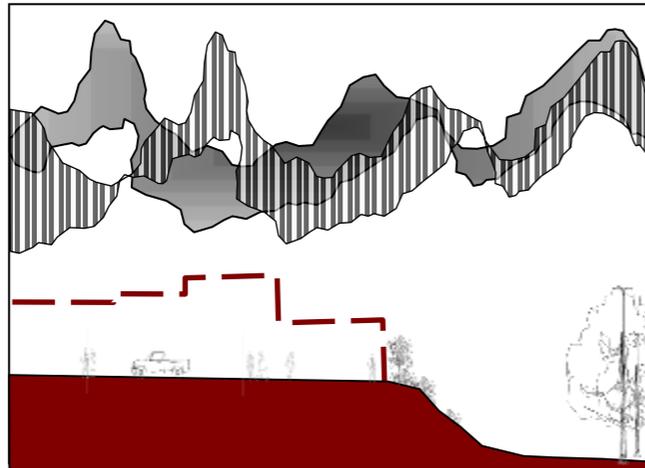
Vista hacia el Este localizada en la Avenida 1 de la Urbanización
